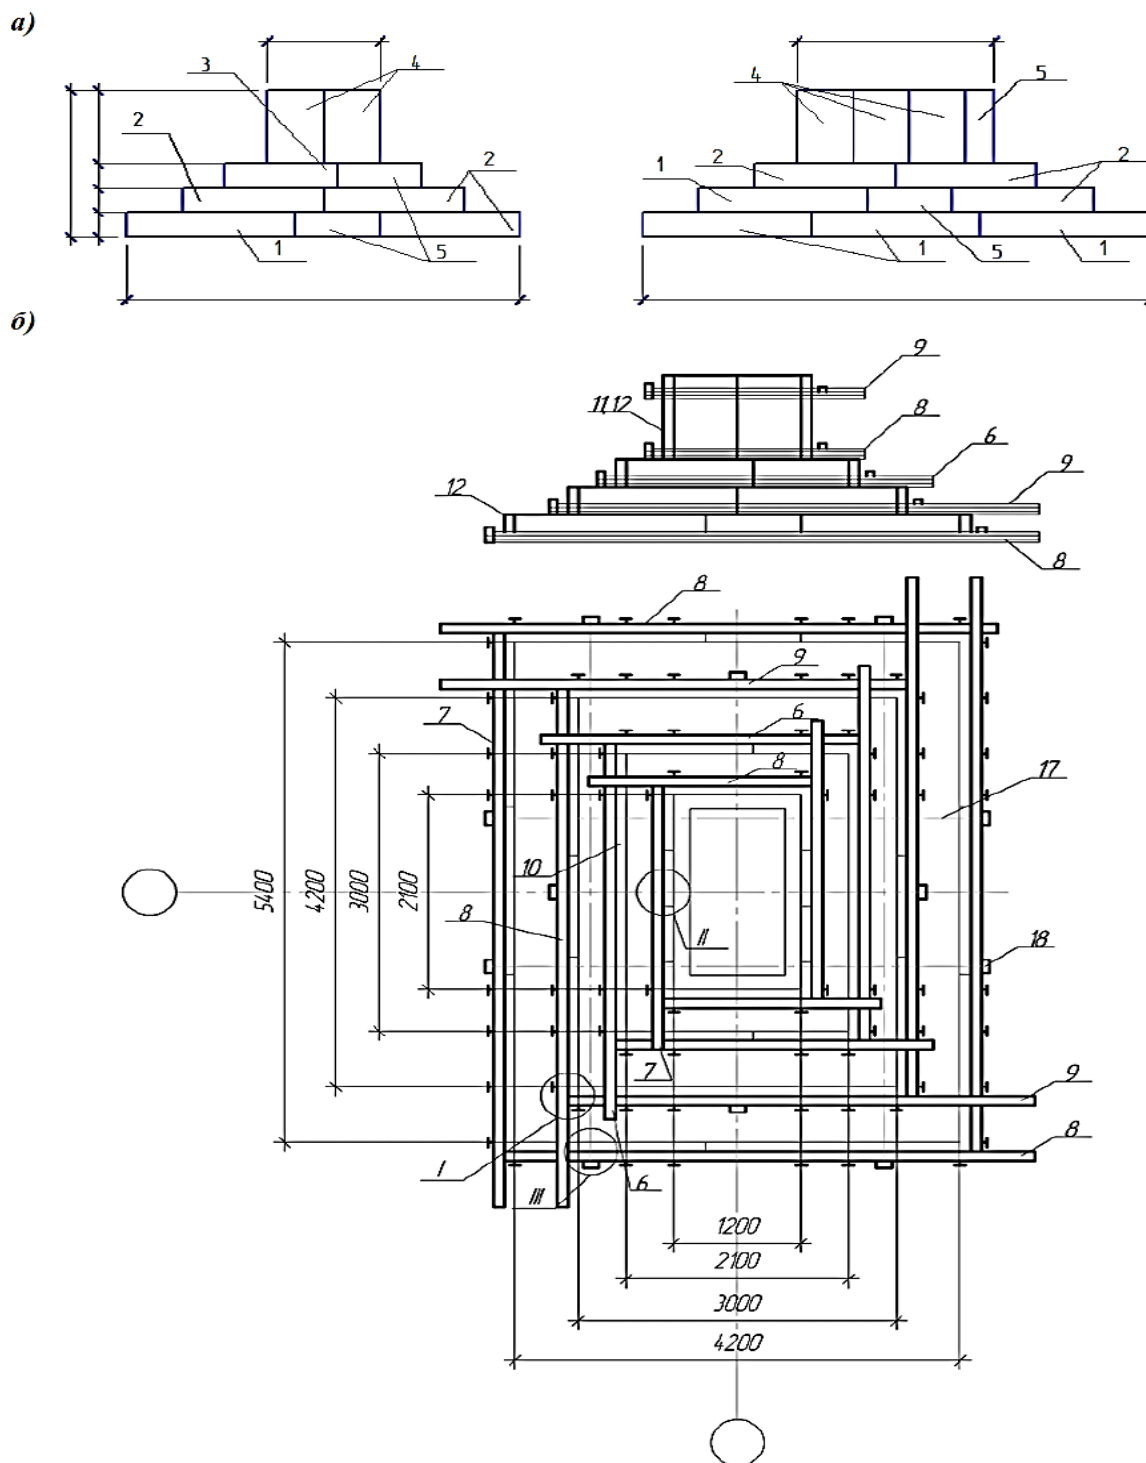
Пример конструирования мелкощитовой опалубки фундамента (ЦНИИОМТП): а- раскладка щитов; б – установка наружных угловых элементов и схваток; 1 – 5 щиты, 6 – 10 – схватки, 11,12 – наружные угловые элементы, 13 – крюк натяжной с клином, 14 – клин (длиной 125 мм), 15 – то же (длиной 80 мм), 16 – палец (длиной 123 мм), 17 – стяжка, 18 – замок стяжки
